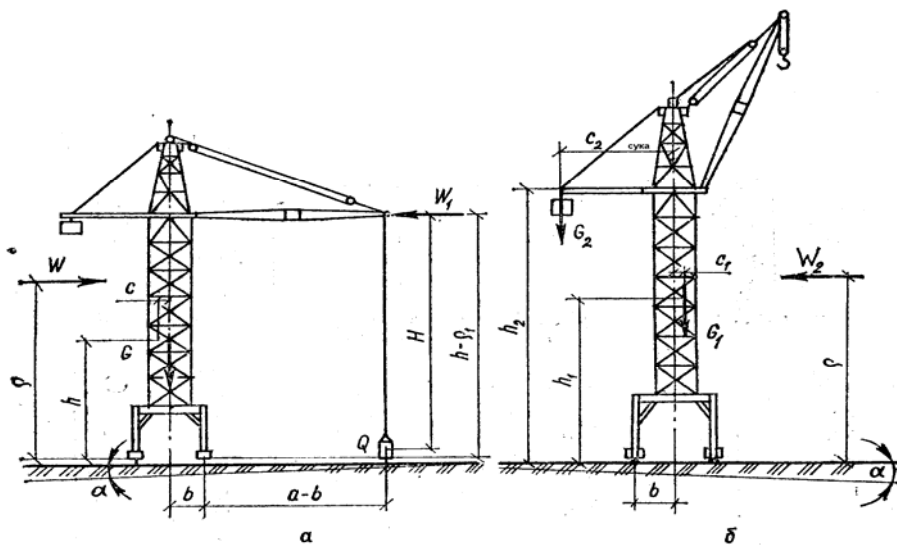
Розрахункова схема стійкості баштового крана з вантажем (а) і без нього (б).
